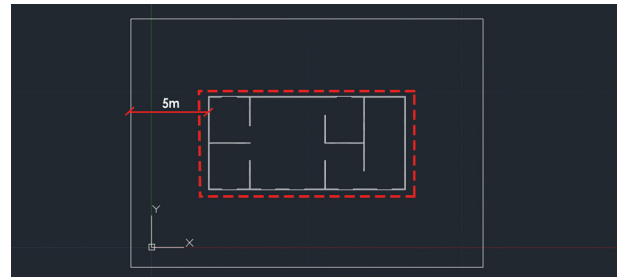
Configuración 2 de la planta arquitectónica del caso base.
